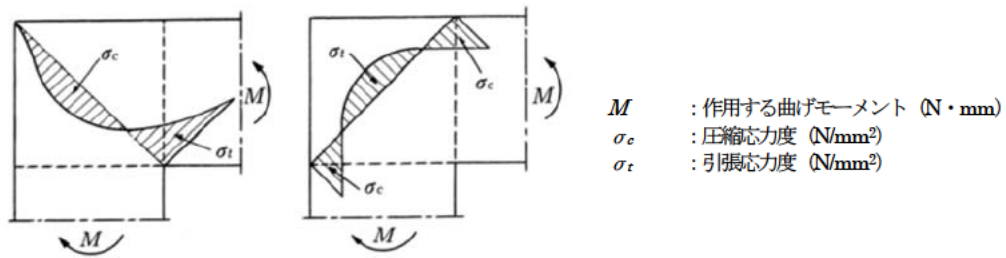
内側引張の曲げモーメントによる接合部のひび割れ
